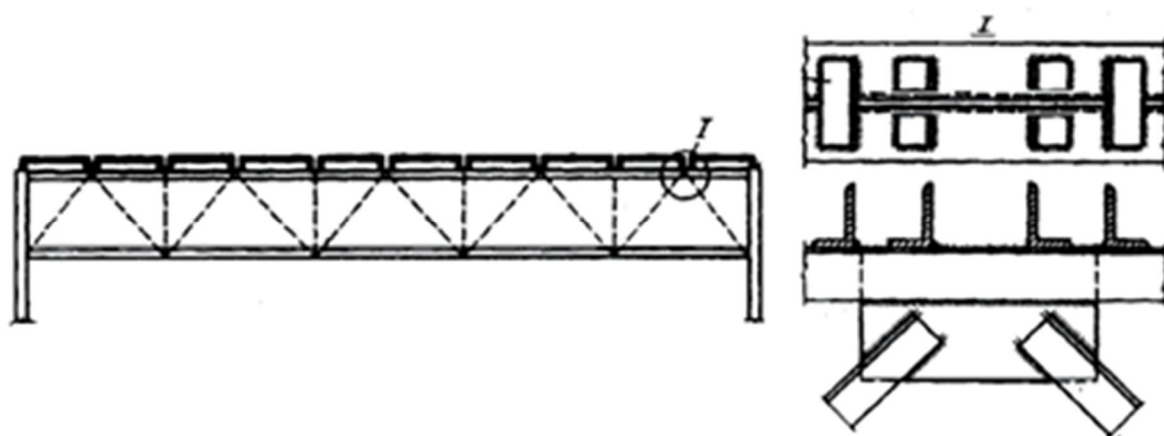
Конструкция сталежелезобетонной фермы
